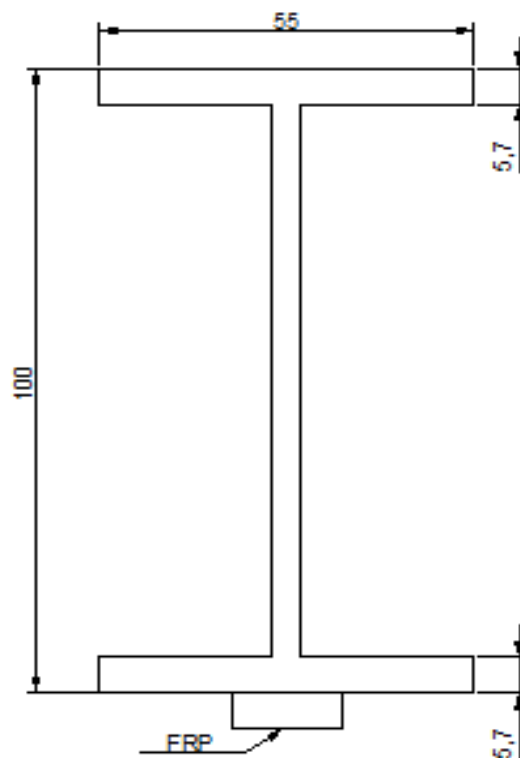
Sección transversal en mm de la viga a emplear reforzada con F.R.P.
